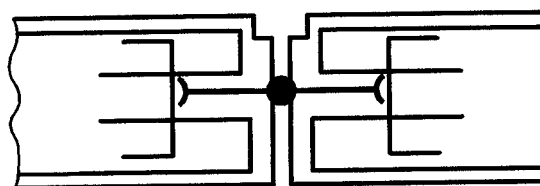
exemple de coupe sur bande d'arrêt d'eau
